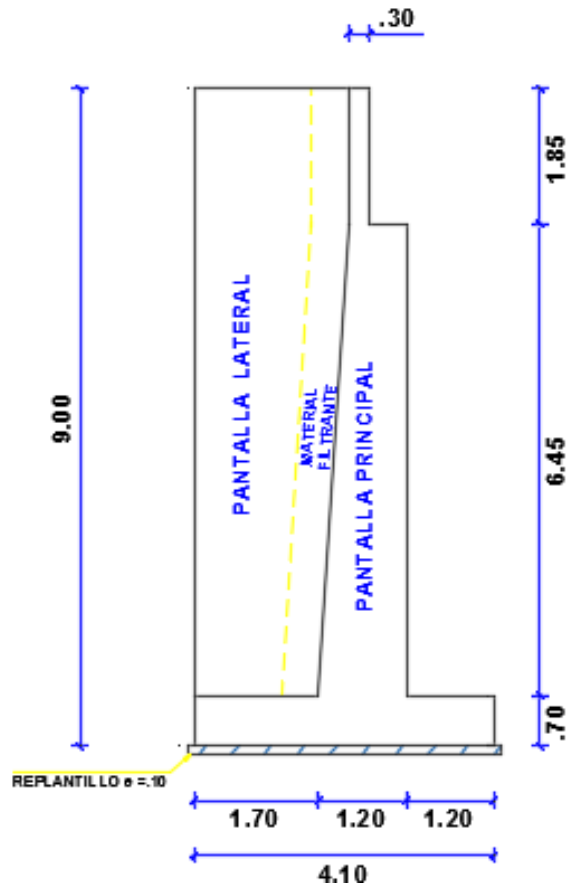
ESTRIBO TIPO IZQUIERDO Y DERECHO.
